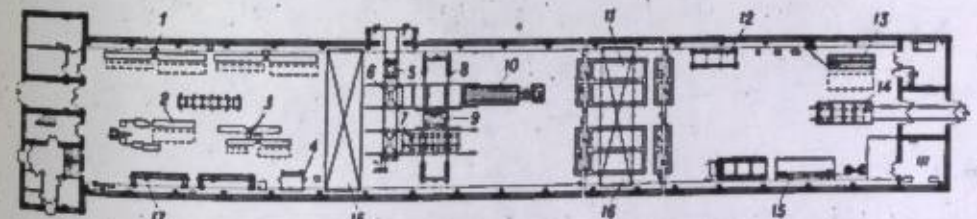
Главный производственный корпус завода железобетонных изделий на два формовочных поста: 1 — точечная машина для сварки; 2 — правально-отрезной станок; 3 — машина для автоматич. сварки; 4 — станок для гибки сеток; 5 — передвижной радиочастотный бункер; 6 — бетононасос; 7 — виброплощадка; 8 — тележка с подъемной платформой; 9 — пригрузочный шпал; 10 — формовочная машина; 11 — камера тепловлажностной обработки; 12 — стенд для контроля изделий; 13 — стенд для испытания изделий; 14 — самоходная тележка для вывоза готовых изделий; 15 — оборудование для напряженной арматуры; 16 — мостовой кран; 17 — подвесная точечная машина.
